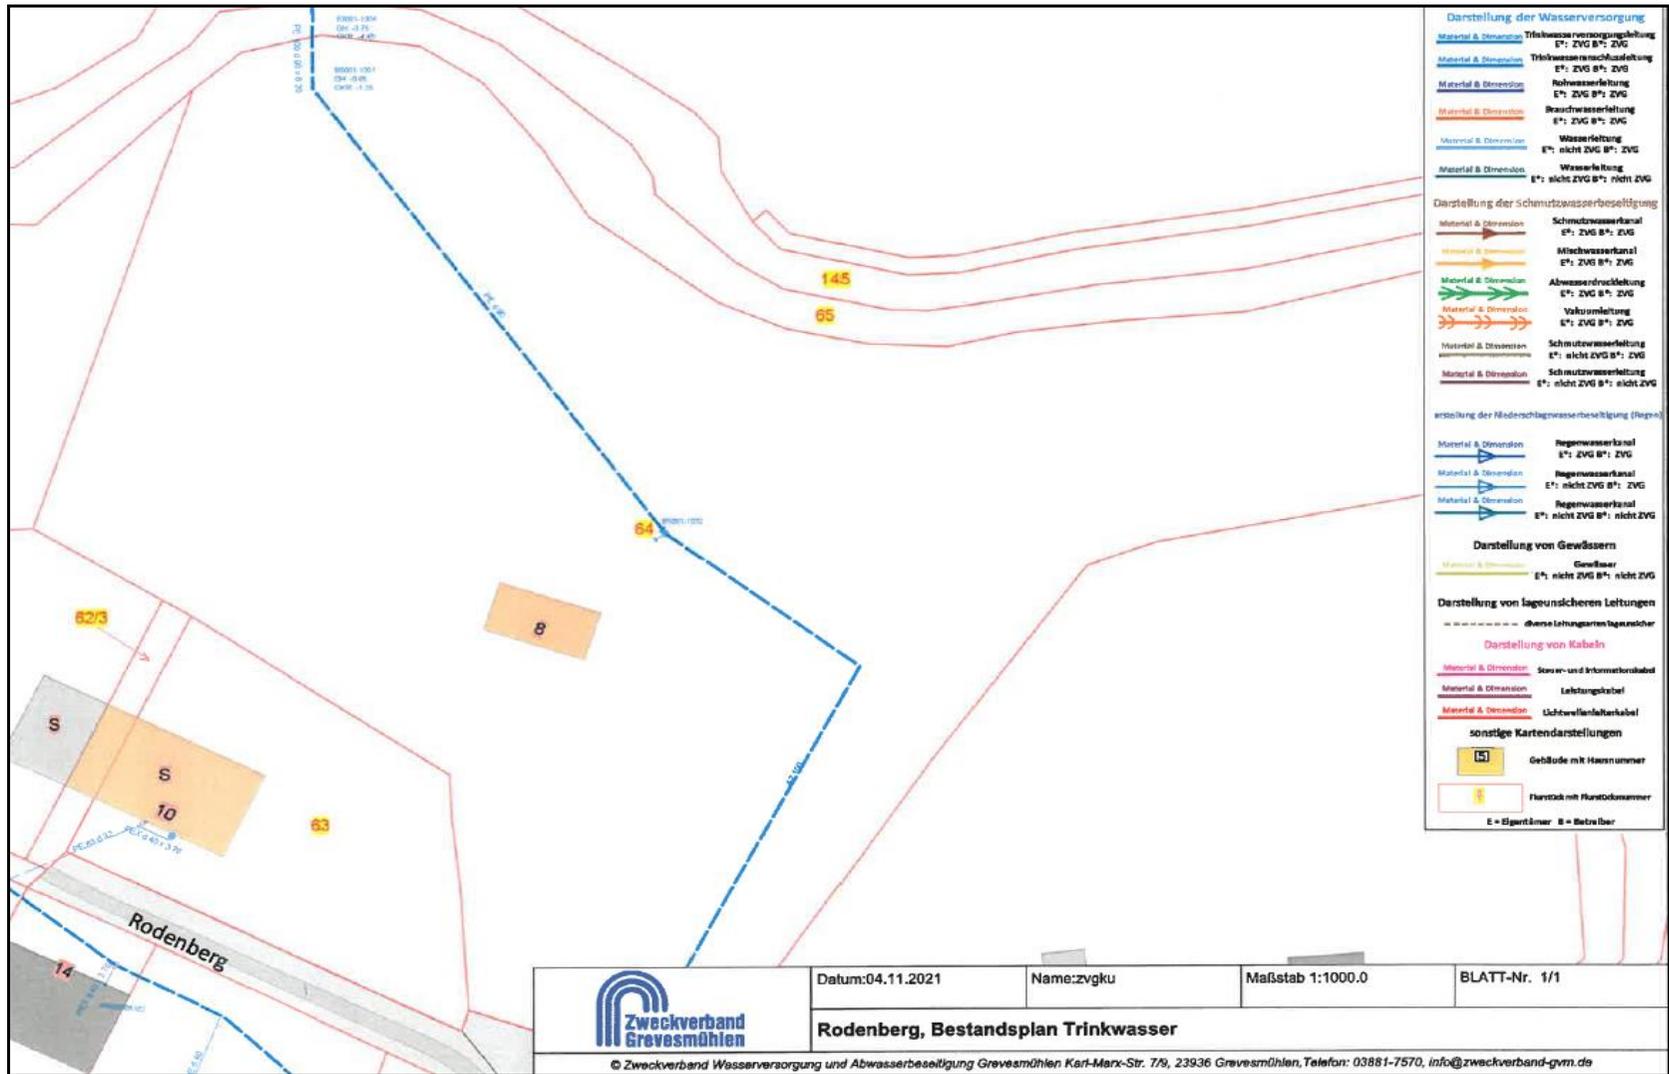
Leitungsplan der Trinkwasserleitung des ZVG, Stand 04.11.2021
